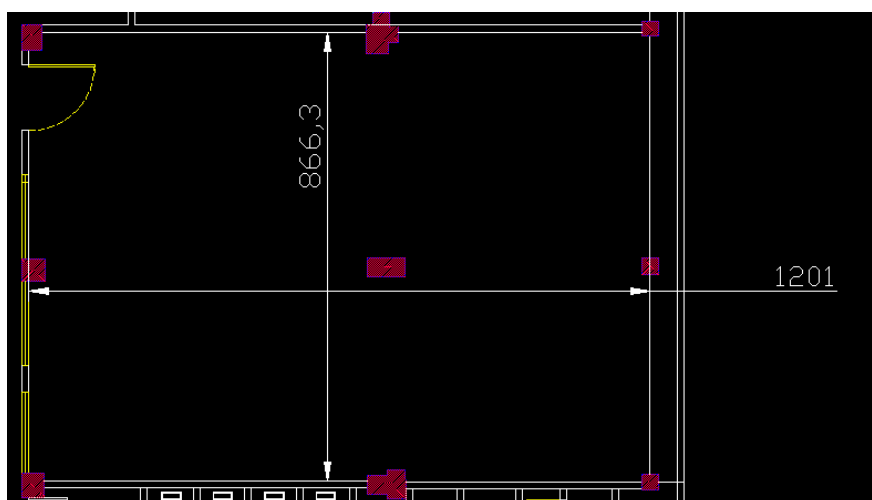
El área aproximada del laboratorio es de 96 metros cuadrados.
